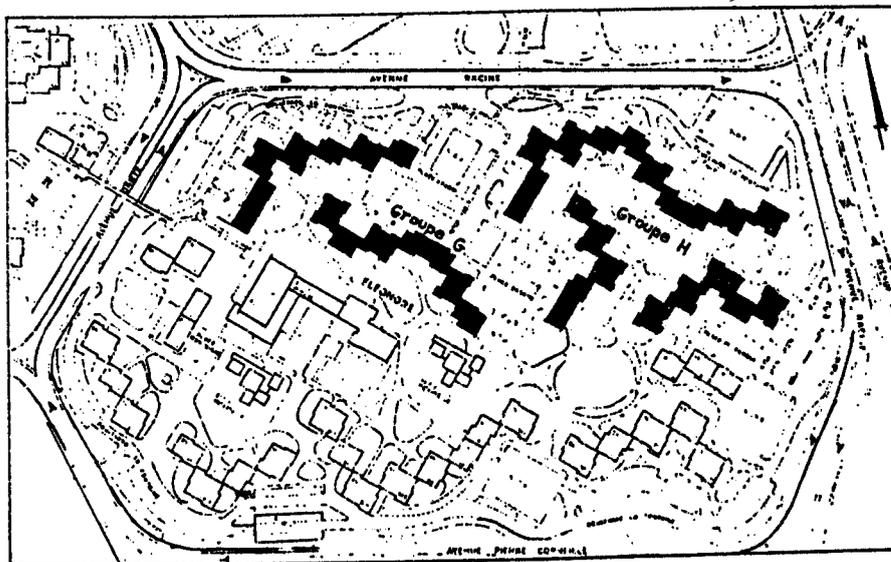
Zup de Hautepierre - Maille Éléonore - Plan de situation des groupes G et H
